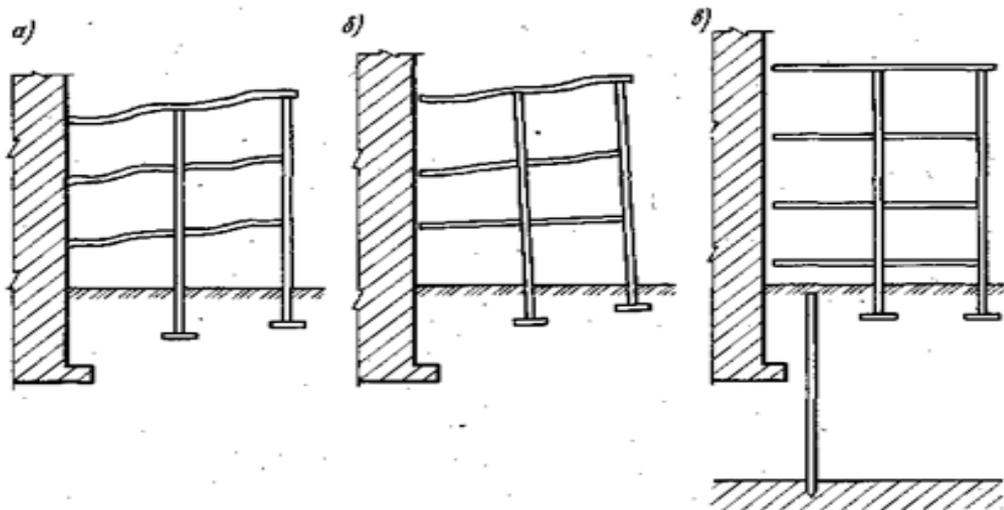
Устройство малоэтажных пристроек около высоких зданий
